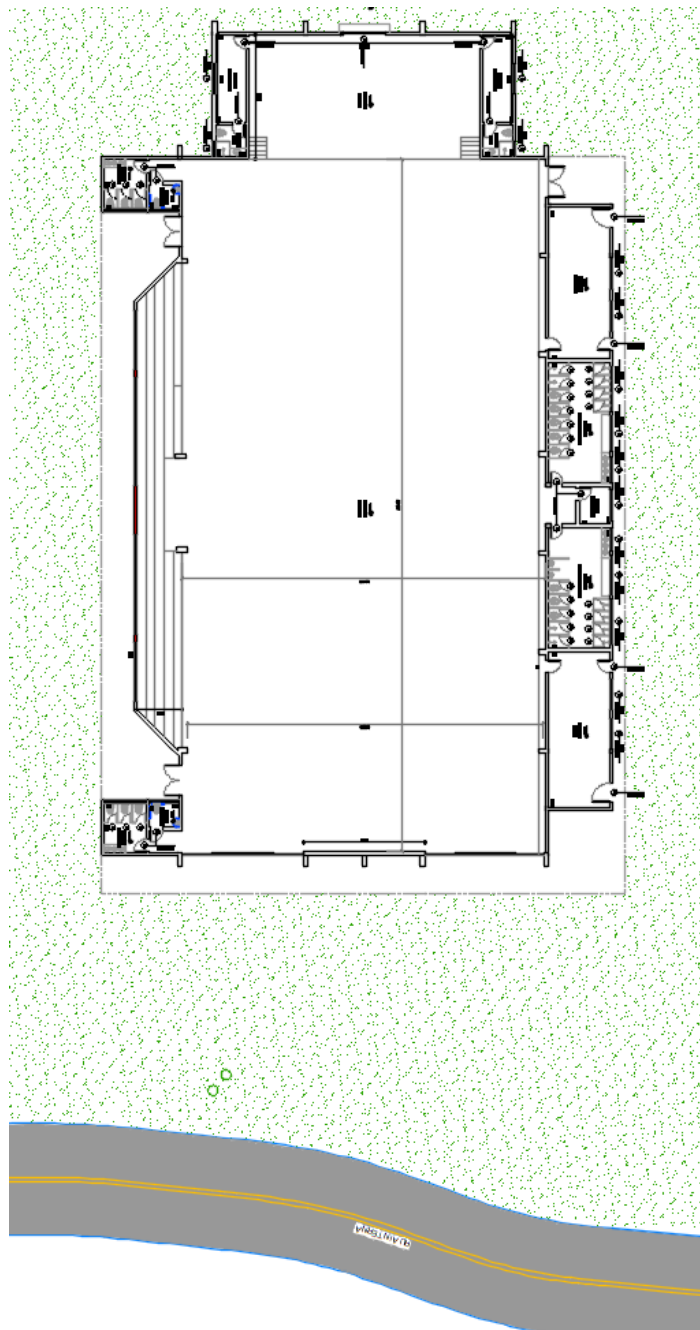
croqui indicando a posição da obra no local – de quem olha da Rua Interna do Campus
